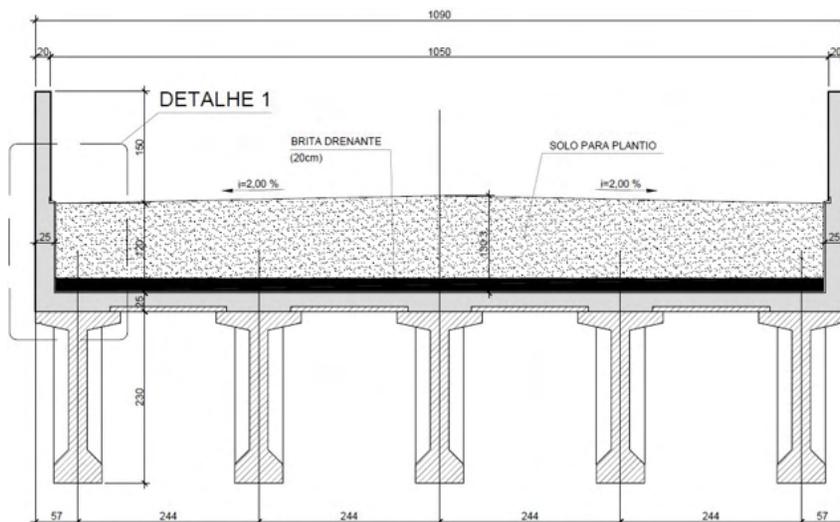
Modelo da superestrutura de uma passagem de fauna elevada
